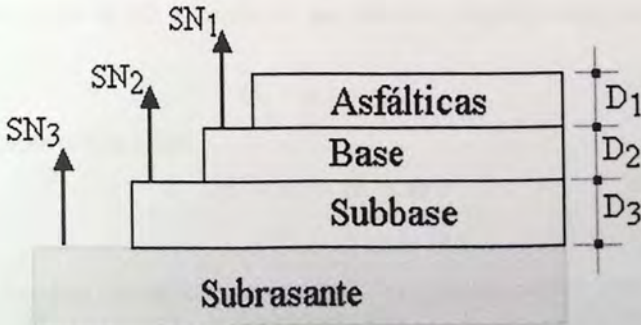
Número estructural en función de las capas de pavimento. [6]
